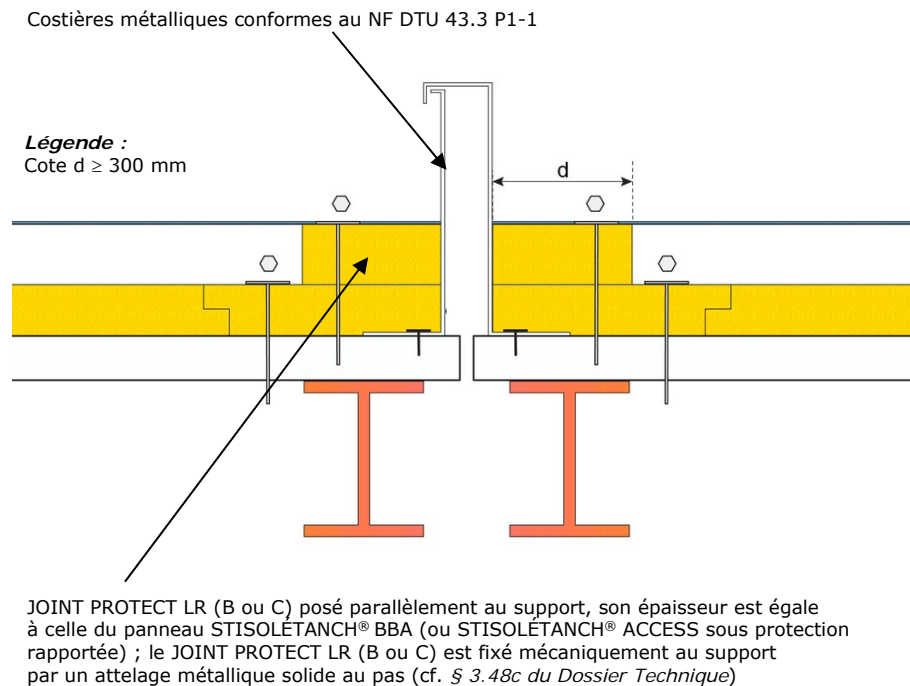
Exemple de traitement au droit d'un joint de dilatation sur élément porteur tôle d'acier nervurée
